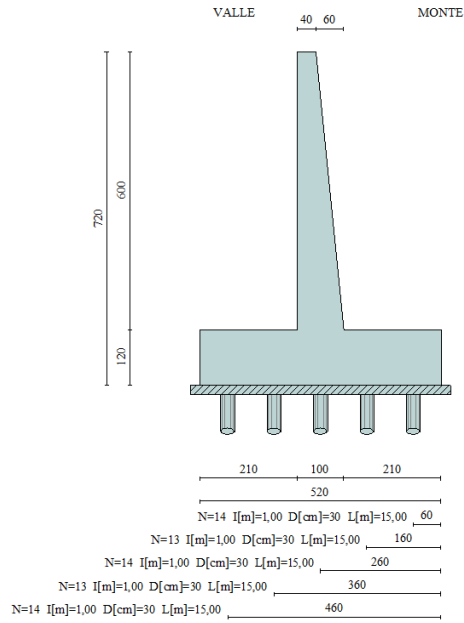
Muro Tipo B: geometria del muro di sostegno.
